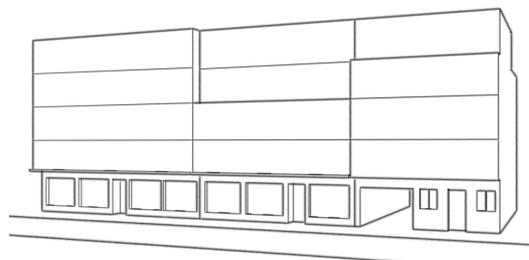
Lange, gegliederte Fassade zur Vermeidung monotoner Strassenbilder mit Durchgang zu den rückwärtigen Nutzungen
